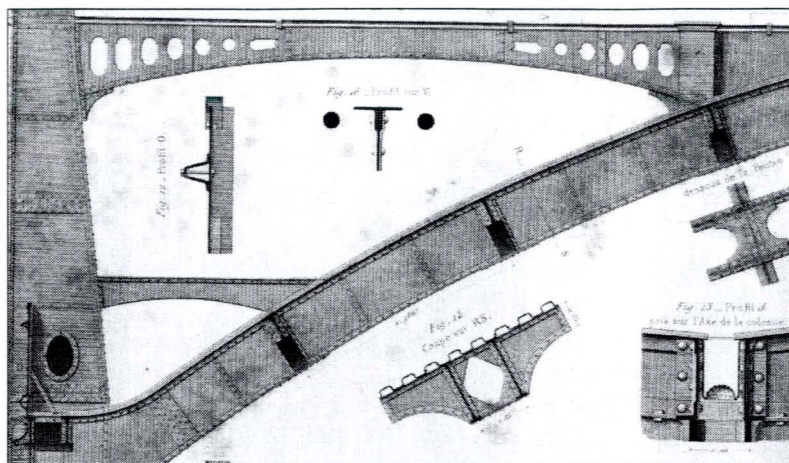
Exposición Universal de París de 1868. Detalles constructivos de la sala central
